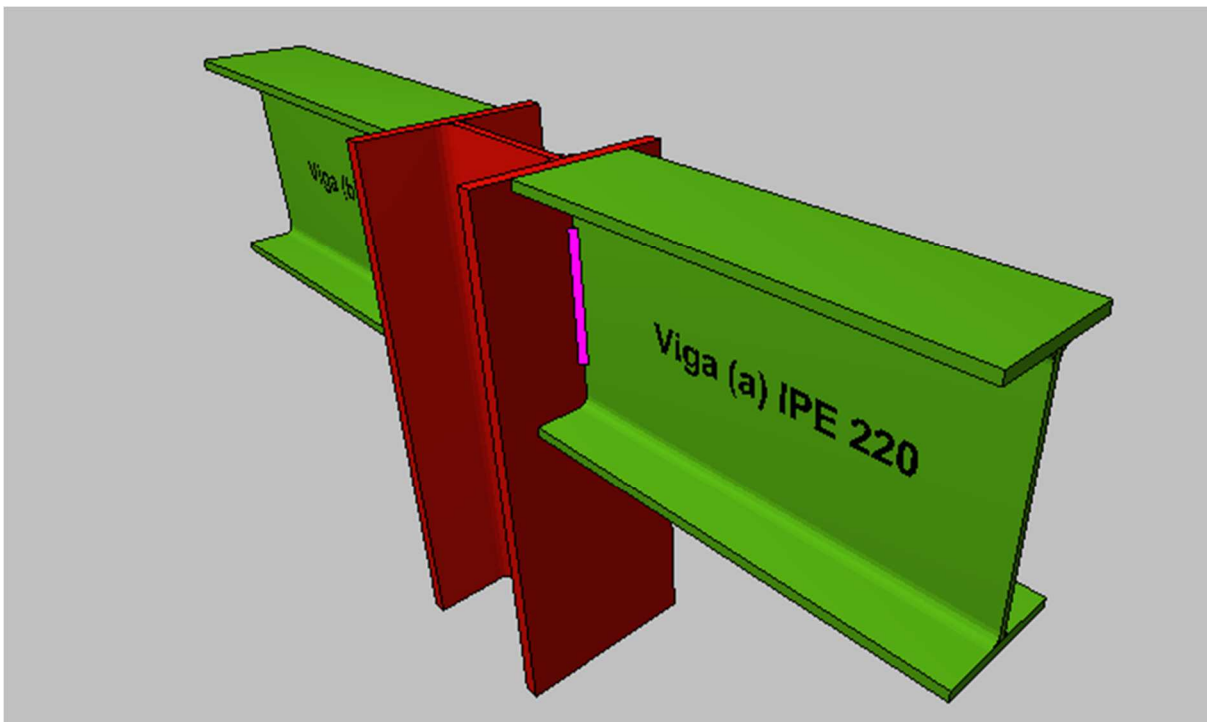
Unión tipo 5 soporte inferior. Viga-pilar-viga
